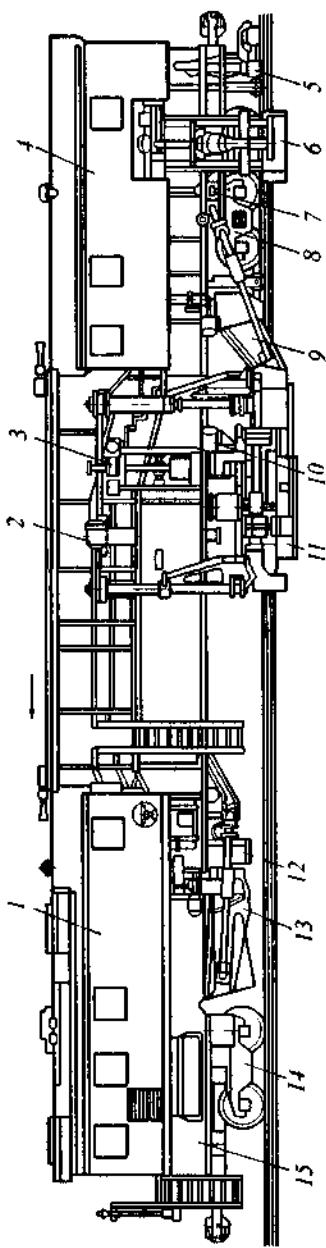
Выправочно-подбивочная машина: 1, 4 — кабины; 2 — механизм подъема плит; 3 — механизм подъема, сдвига и перекоса (выправки) пути; 5 — штальная щетка; 6 — уплотнитель откосов; 7 — выключатель рессор; 8, 14 — тележки; 9 — планировщик; 10 — механизм сдвига виброплит; 11 — основная вибрационная уплотнительная плита; 12 — рельсовые щетки; 13 — дозатор; 15 — ферма
